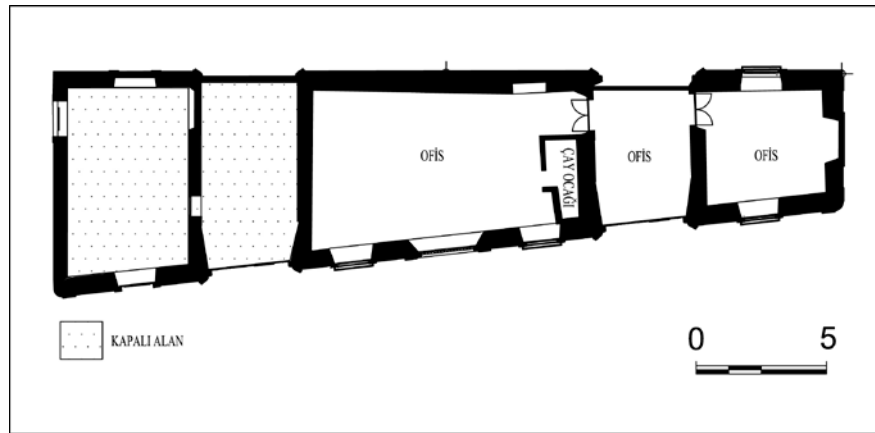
I. Dönem Fransız Gümrük Binası Plan Şeması
